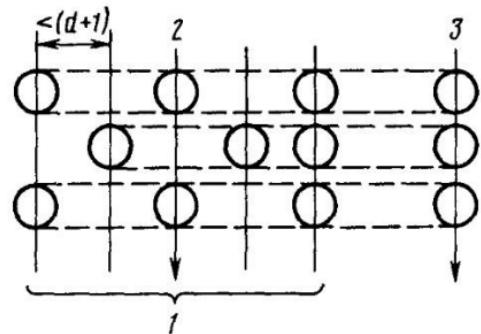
Схема определения коэффициента K при оболочках или столбах, расположенных в шахматном порядке:
